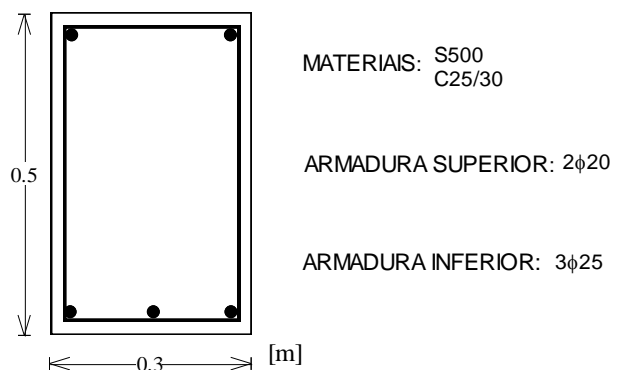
Secções de betão armado adoptadas para as vigas e pilares.
